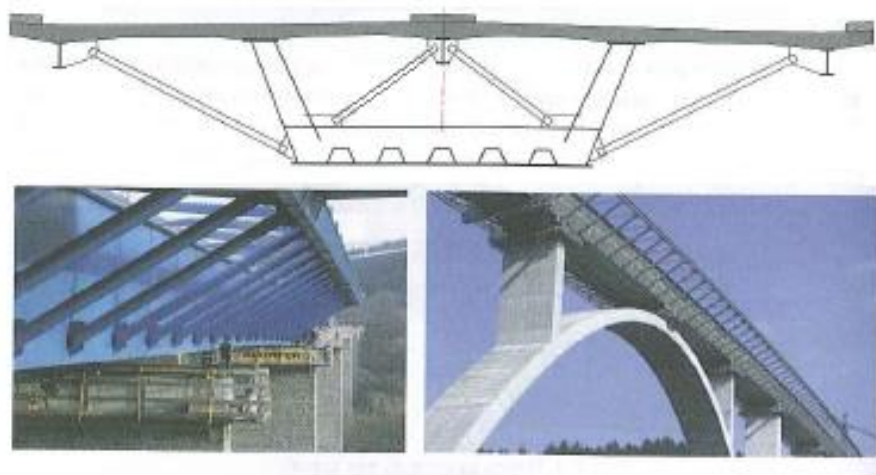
Сталезалізобетонних балка коробчатого перетину зі збільшеними консолями залізобетонної плити
